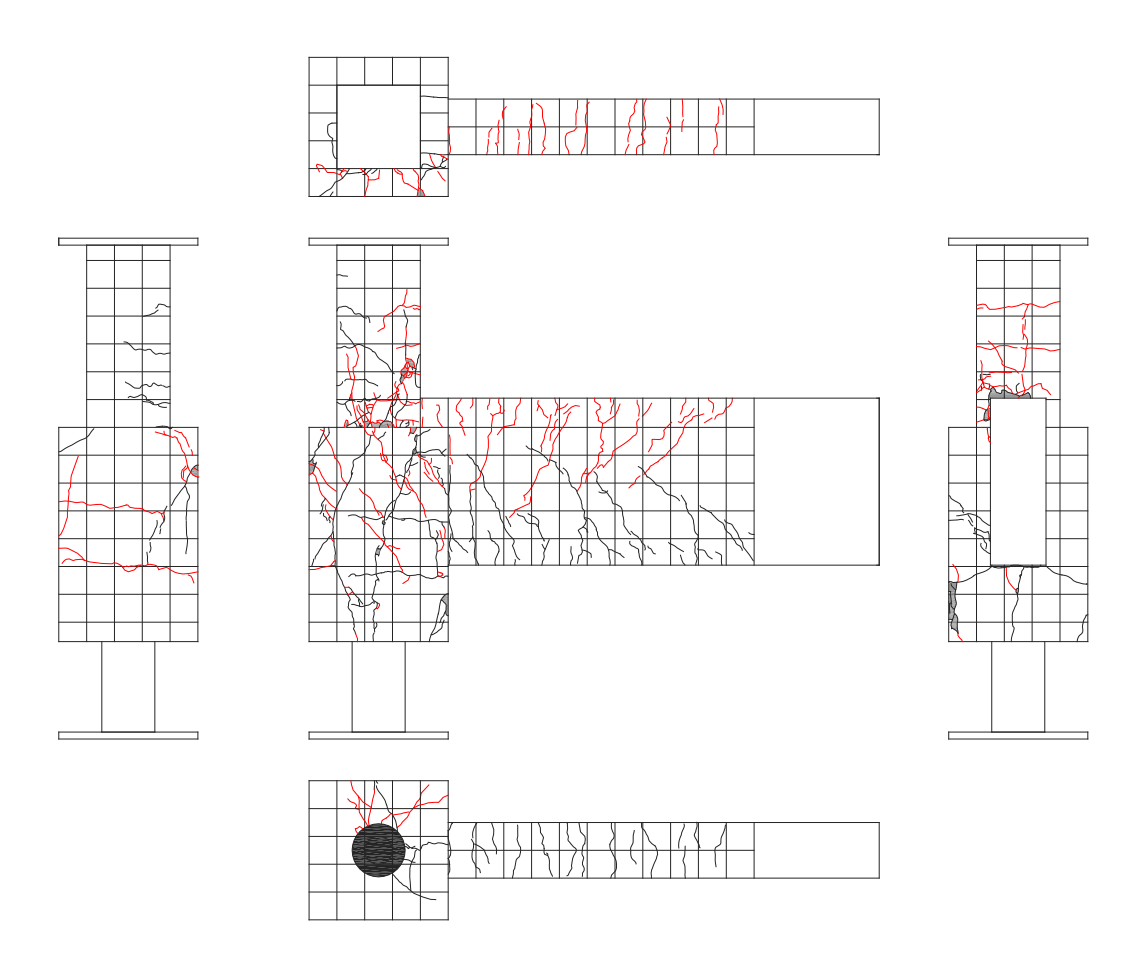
試験体 A-4 ひび割れ状況 (7Cycle)
